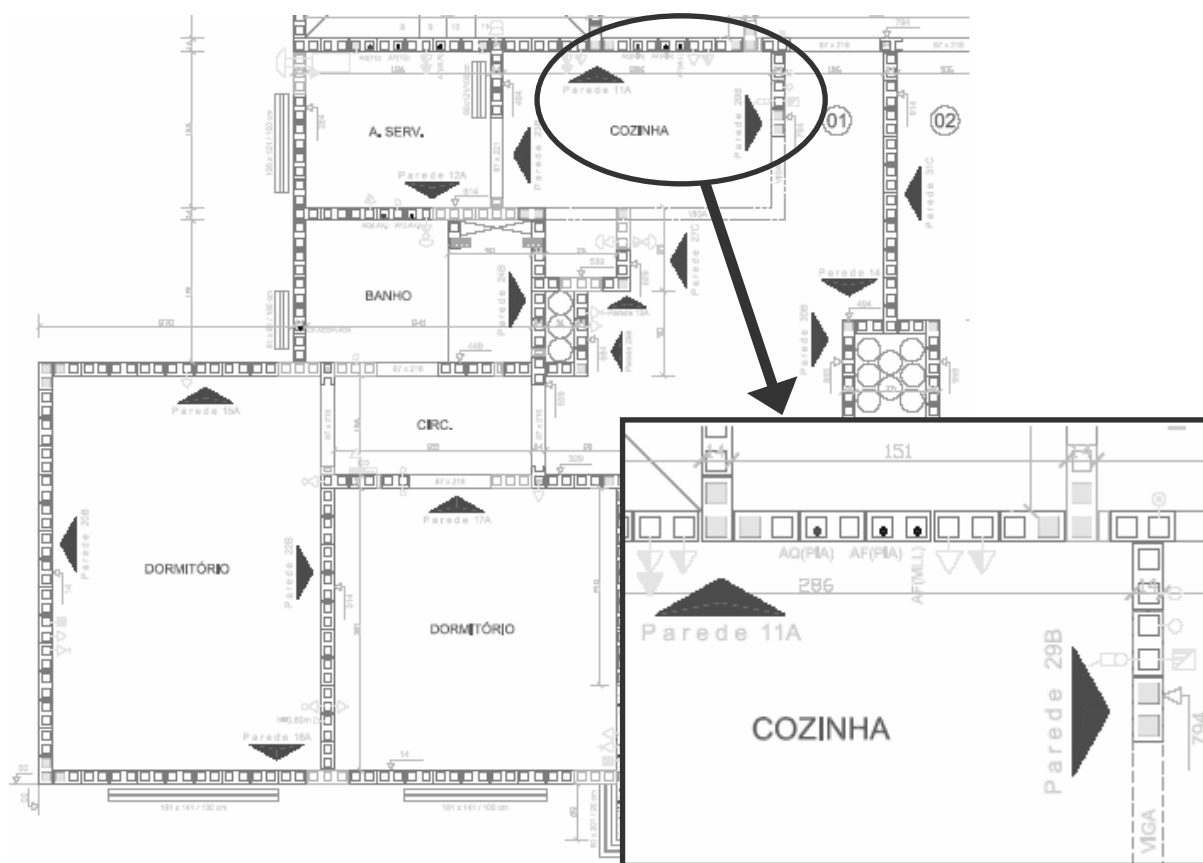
exemplo de uma planta da primeira fiada com detalhe das instalações da cozinha
